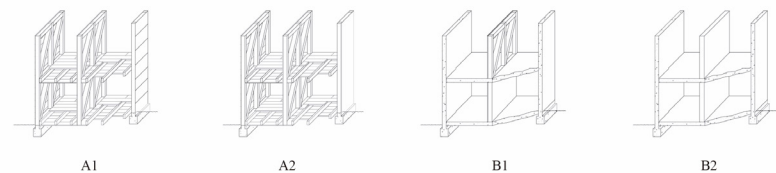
Trazado estructural de las fachadas cubiertas de las cuatro tipologías – 1850-1960. Fuente: Preparada por los Autores.
